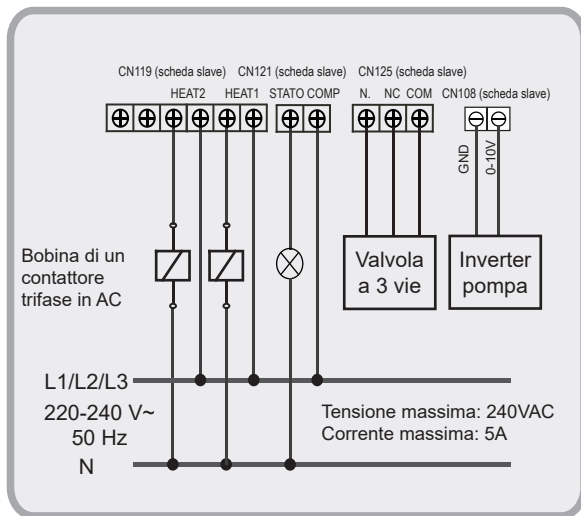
Cablaggio del riscaldatore ausiliario della conduttura e della luce AC dello stato del compressore (65 KW e 110 KW)
